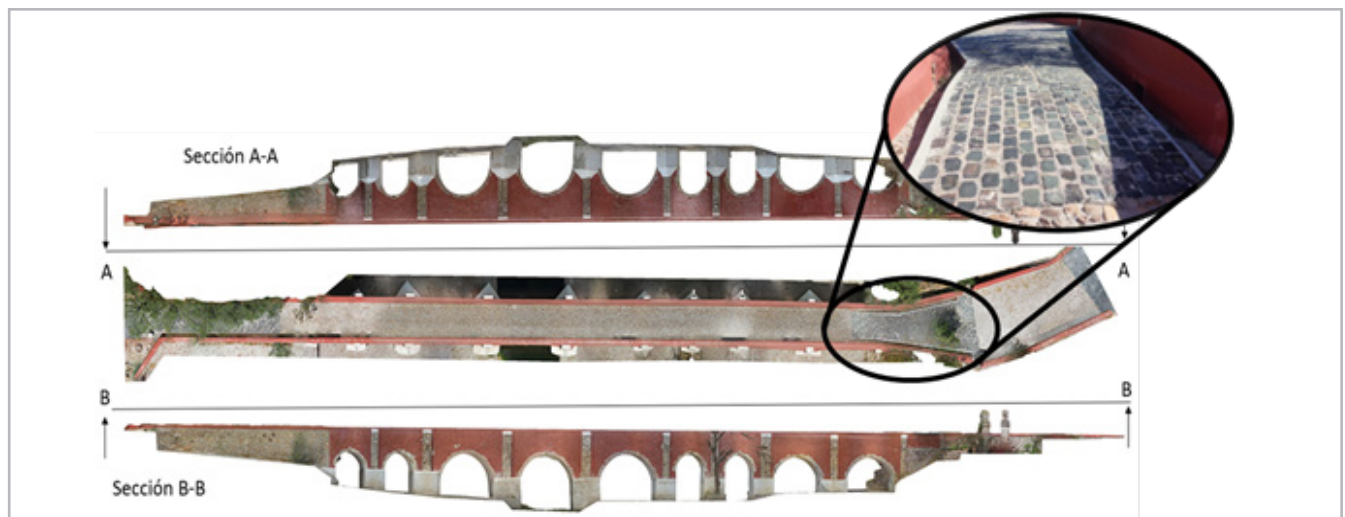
Ortofotos de planta y fachadas, puente San Ignacio tras su restauración y la rampa de acceso al puente “San Ignacio” tras la peatonalización, construida con las baldosas de escoria de fundición. Modificada a partir de Valdez (Valdez 2023:98).
